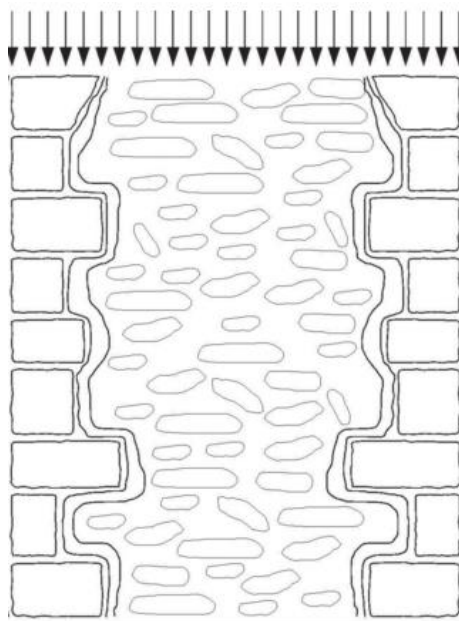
Corte transversal de alvenaria com carregamento uniforme [36]
